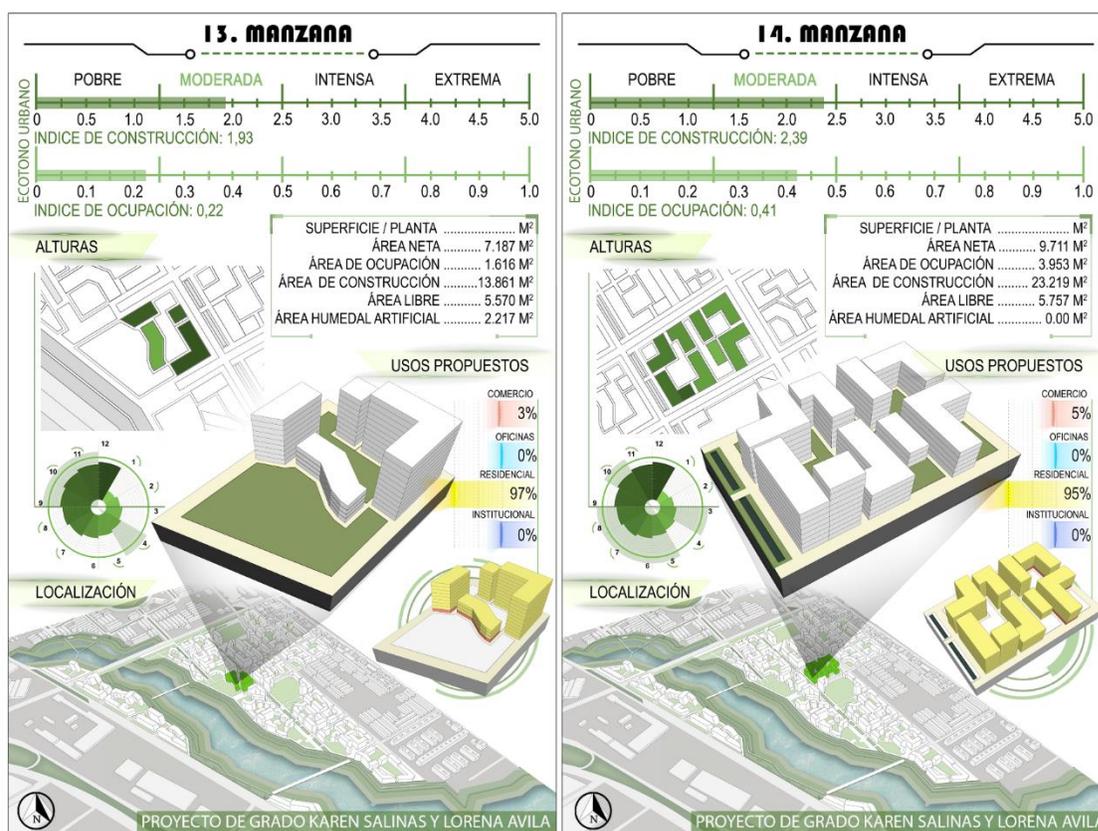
Manzana 13 y 14. Autoria propia (2019)
